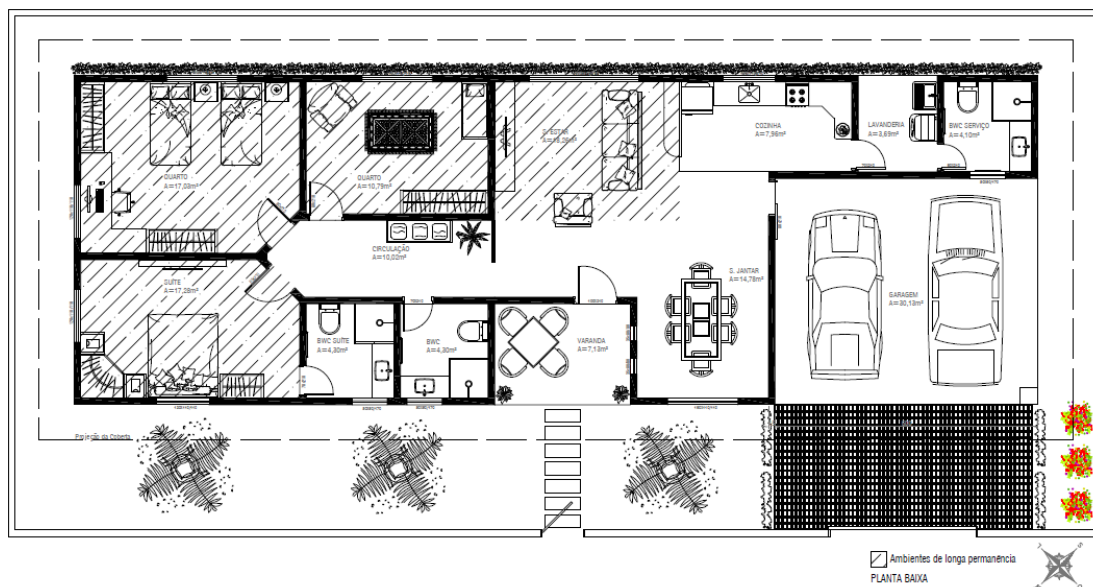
Planta baixa da edificação. Fonte: elaborado pela autora
